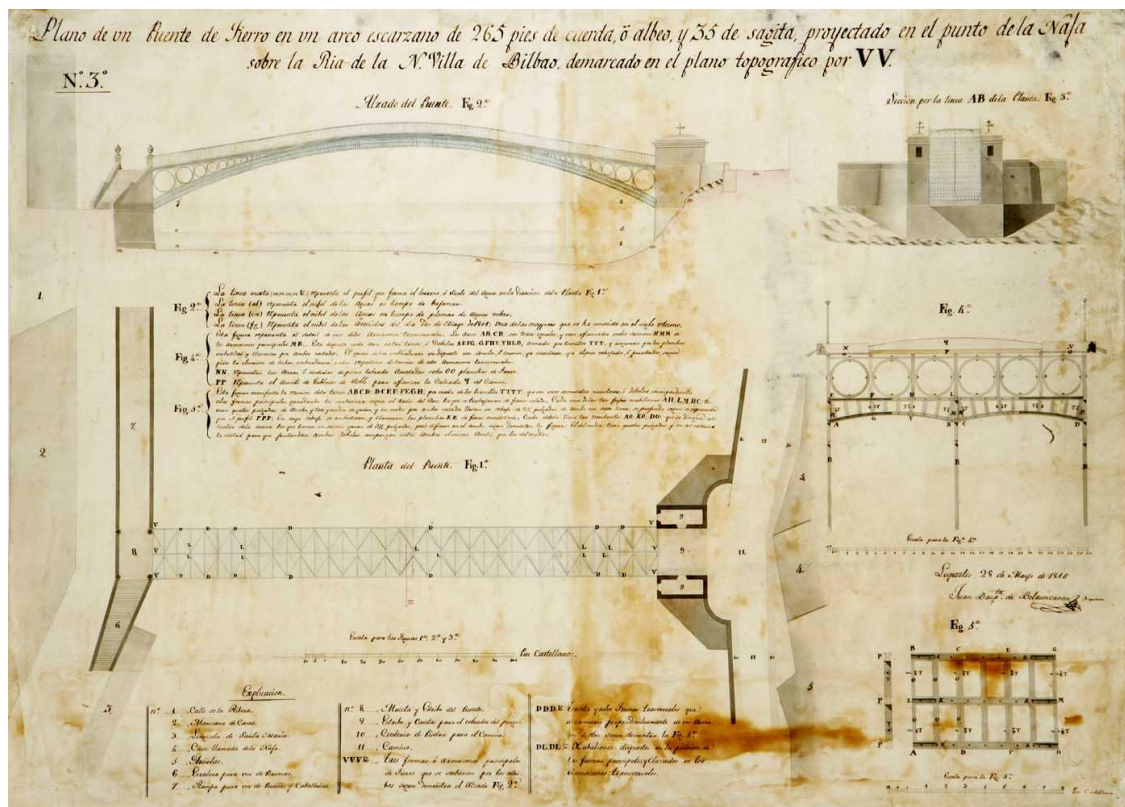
Plano de un Puente de Hierro en un arco escarzano de 265 pies de cuerda, ó albeo, y 35 de sagita, proyectado en el punto de la Naja sobre la Ria de N. Villa de Bilbao, demarcado en el plano topografico por VV.
